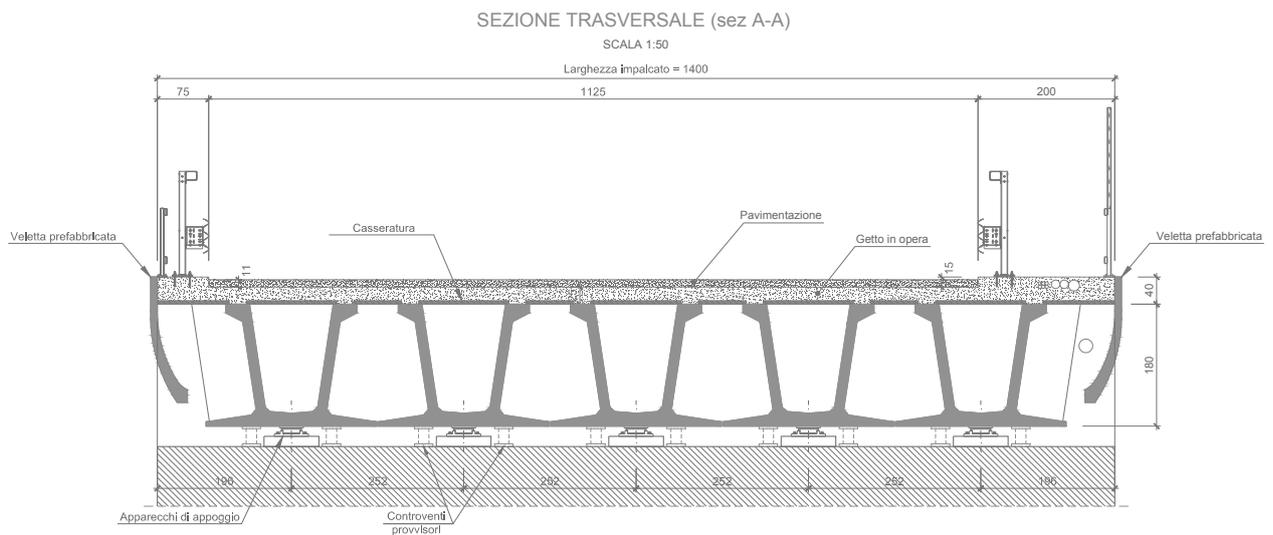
Sezione trasversale Ponte Torrente Chiavon asse Sud
